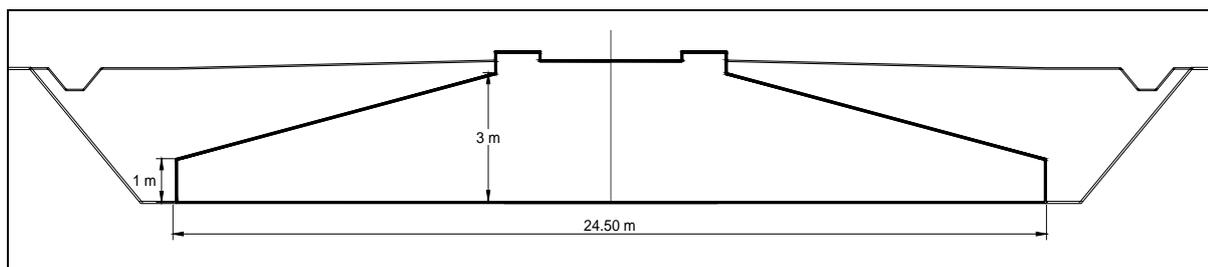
Tipico sezione fondazione Aerogeneratore.
